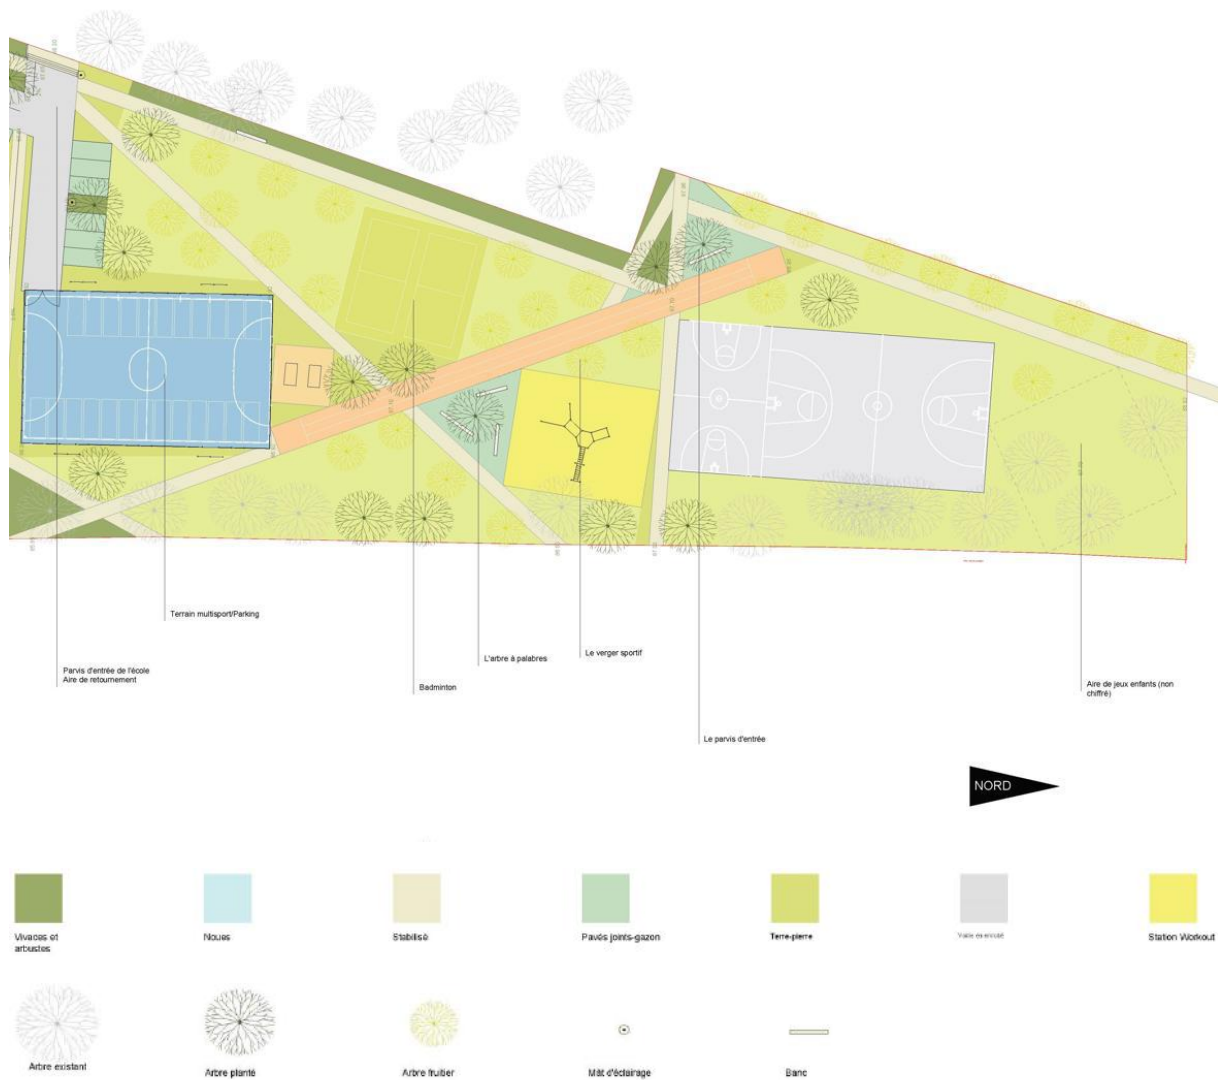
Plan masse paysage pour les espaces extérieurs du projet.
